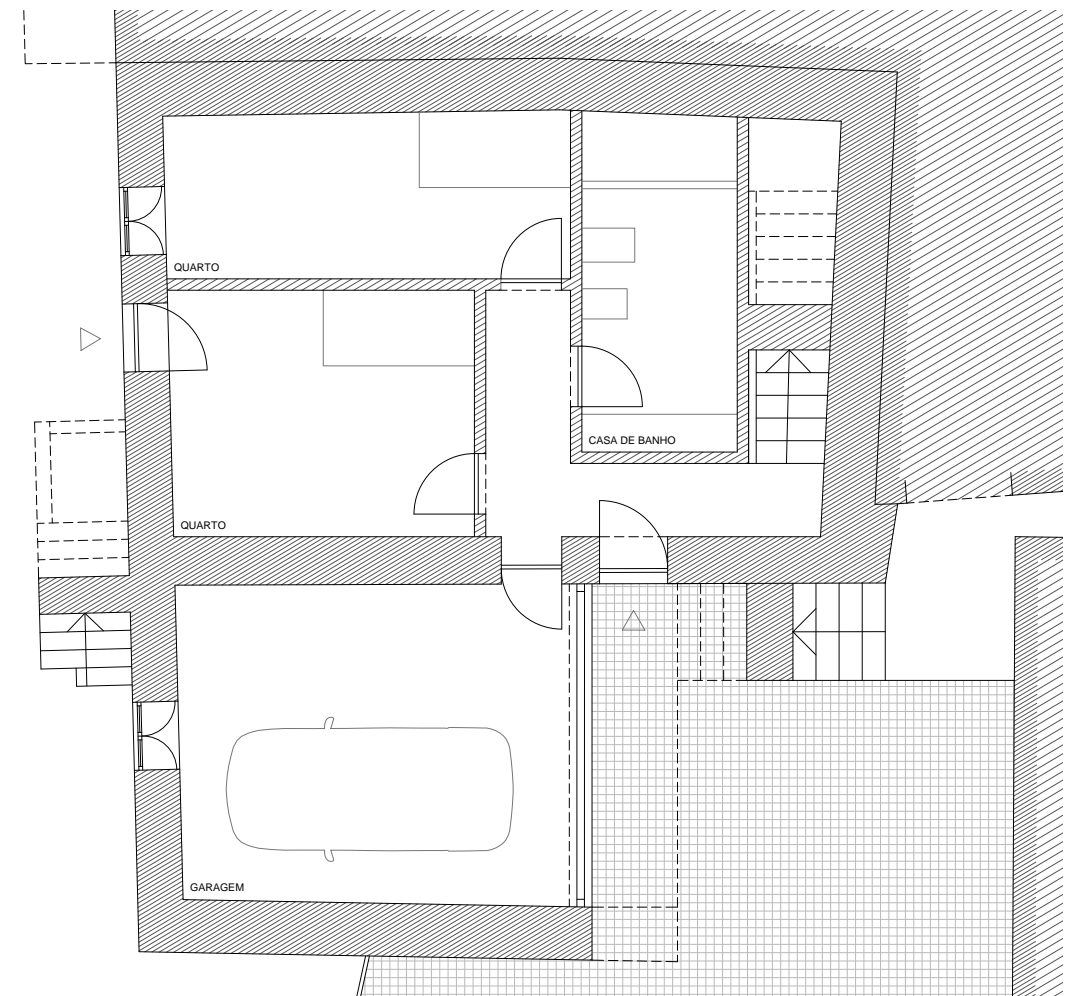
Piso inferior da alternativa com garagem da Hipótese B. Escala 1:100.
